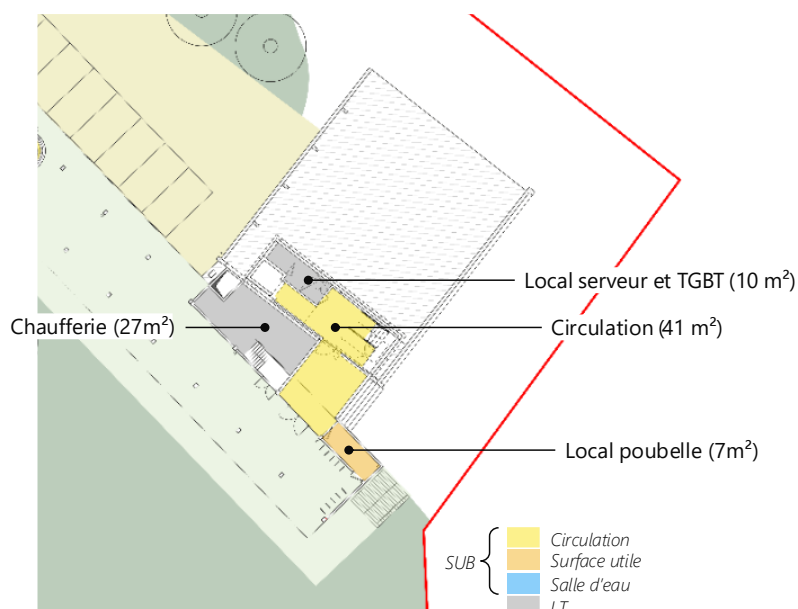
Plan RDJ – Source : Egis sur fond de plan Carrière Didier Gazeau Architecte
